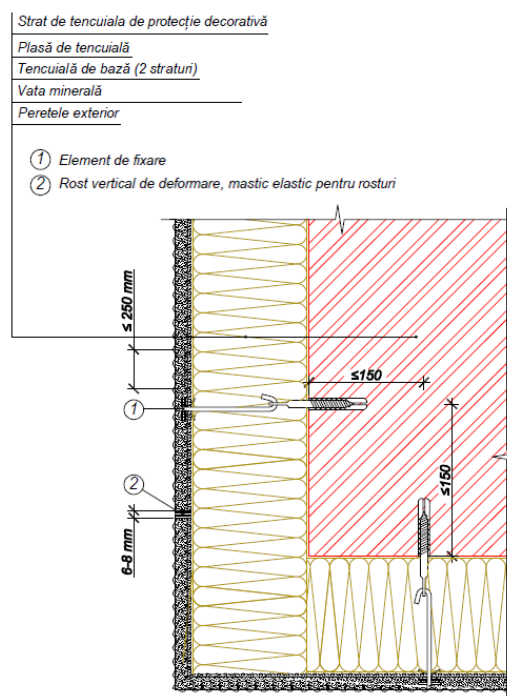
Izolarea termică a colțului extern și amenajarea rostului vertical de deformare. Profil orizontal
